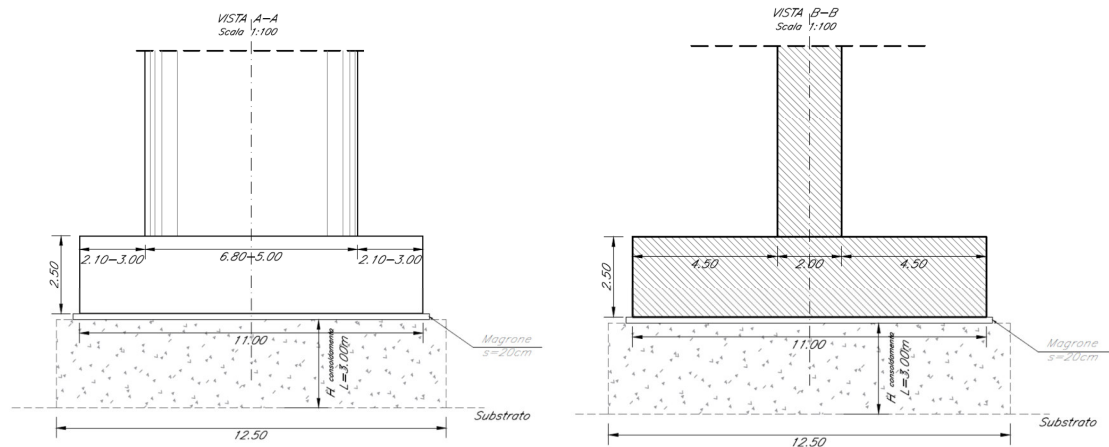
Sezione fondazione diretta su colonne in jet grouting D1500 interasse $i=2.20$ m
